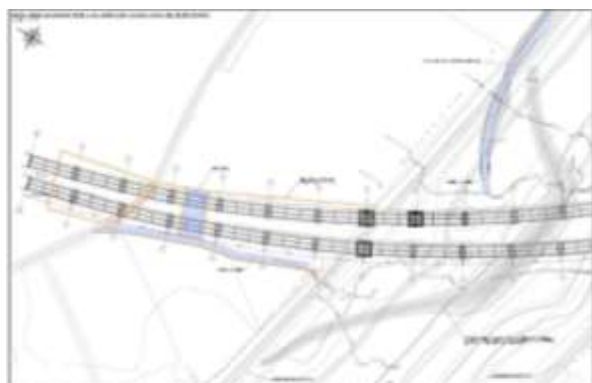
area di cantiere e accessibilità per il risarcimento delle pile da 7 a 10
